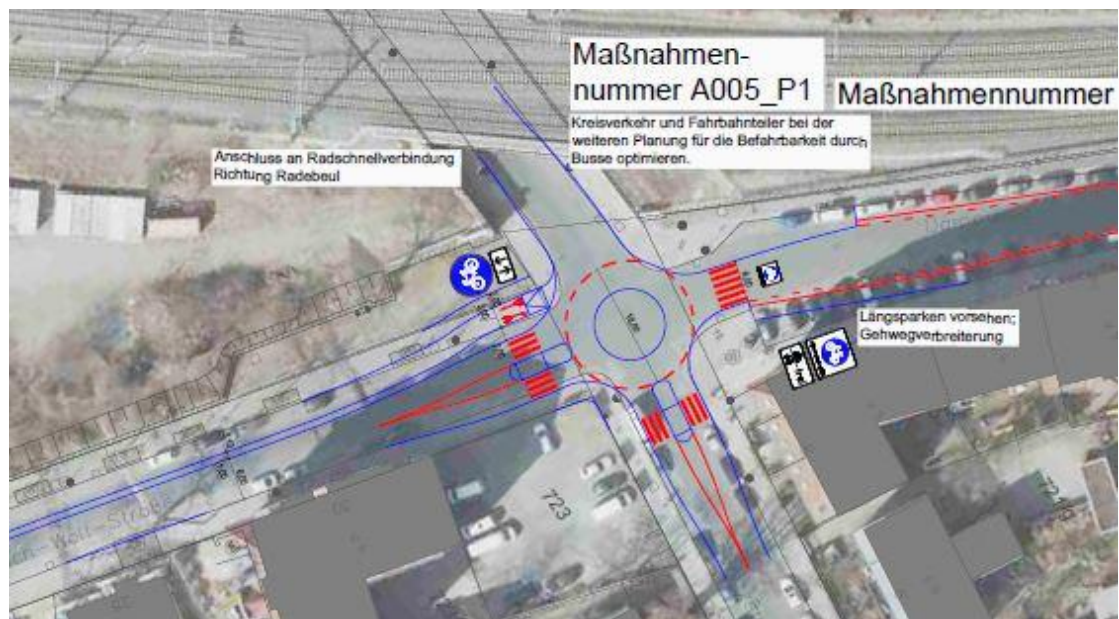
Korridor Klotzsche/Langebrück, Beispiel Lageplan Knoten Dr. F.-Wolf-Straße/Lößnitzstraße
